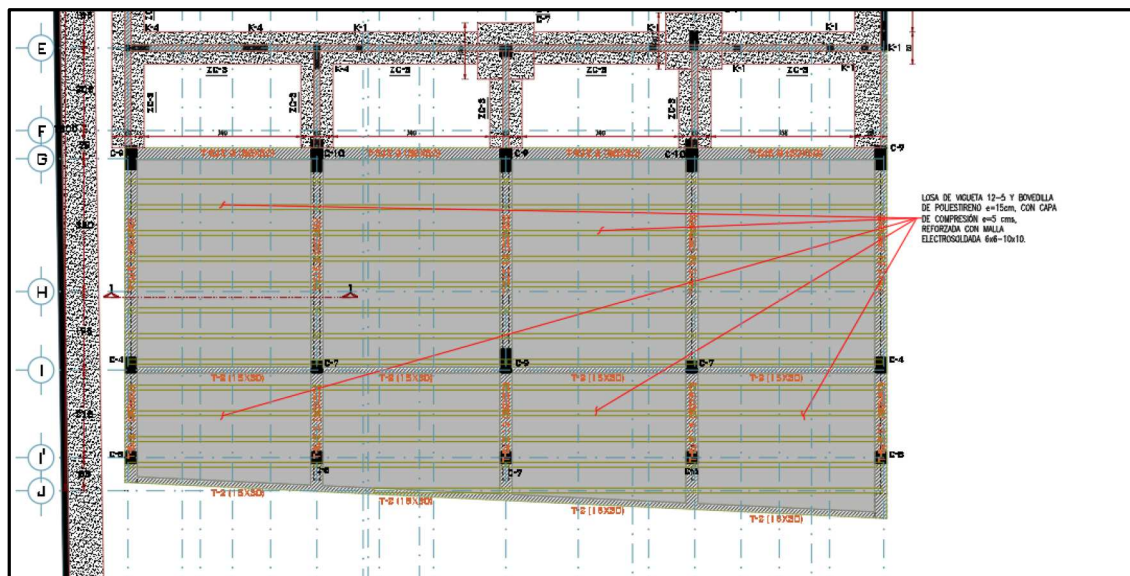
Losa de vigueta y bovedilla, correspondiente al primer nivel.
